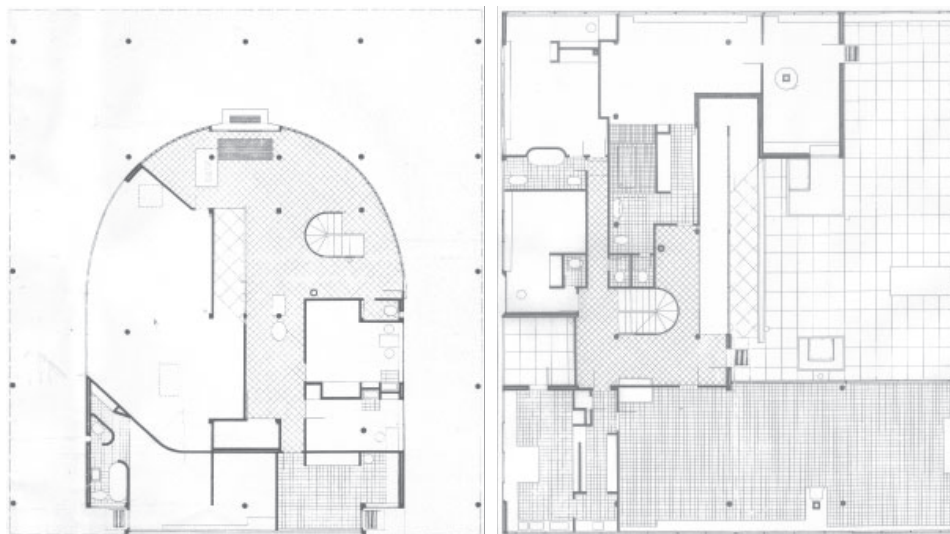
Planos de la planta baja y primera de la Villa Savoye, a escala 1:50, 1972. FUTAGAWA, Y. "Le Corbusier. Ville Savoye, Poissy, France 1929-31" en GA nº 13, Tokio 1972.
